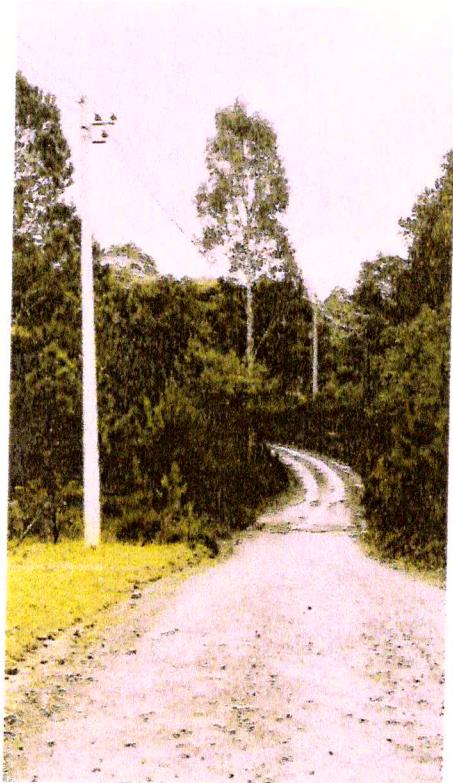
Prolongamento existente da rua Olavo Luiz da Silva visto de dentro da área da empresa Serra Gaúcha, com destaque para a rede elétrica.
